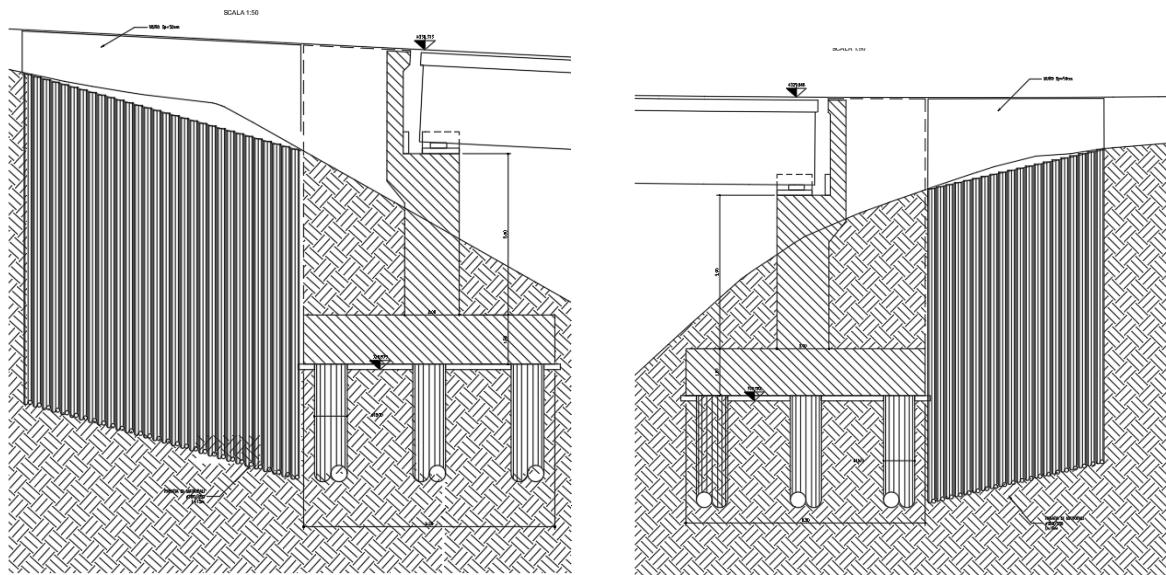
Muri di appoggio Spalla A e Spalla B
